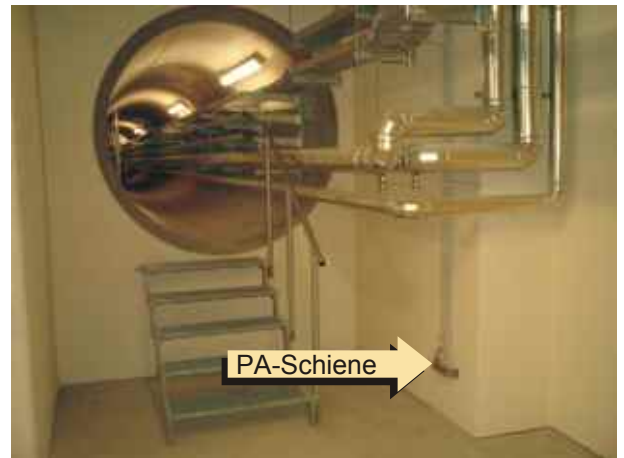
Potentialausgleich an Eintrittsstelle ins Gebäude
